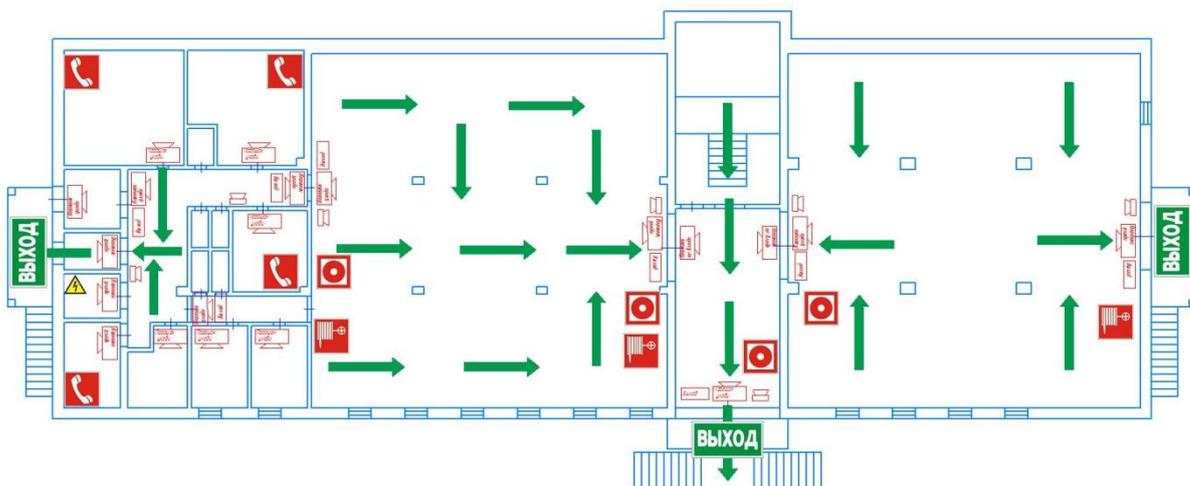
Планы эвакуации из помещений 1-го этажа
